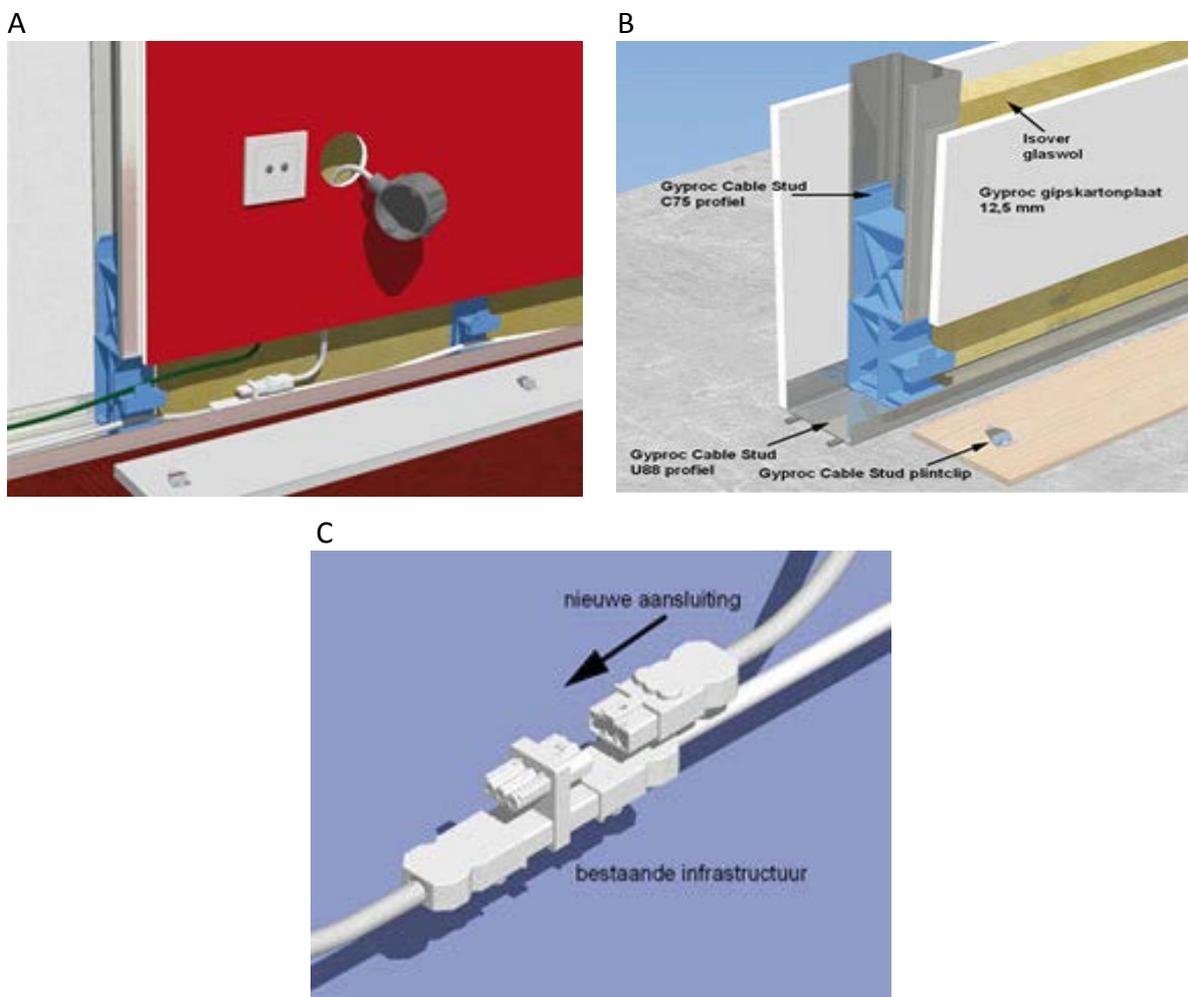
Démontabilité d'une installation électrique dans une cloison (source : Gyproc et OVAM) [52, 111].
